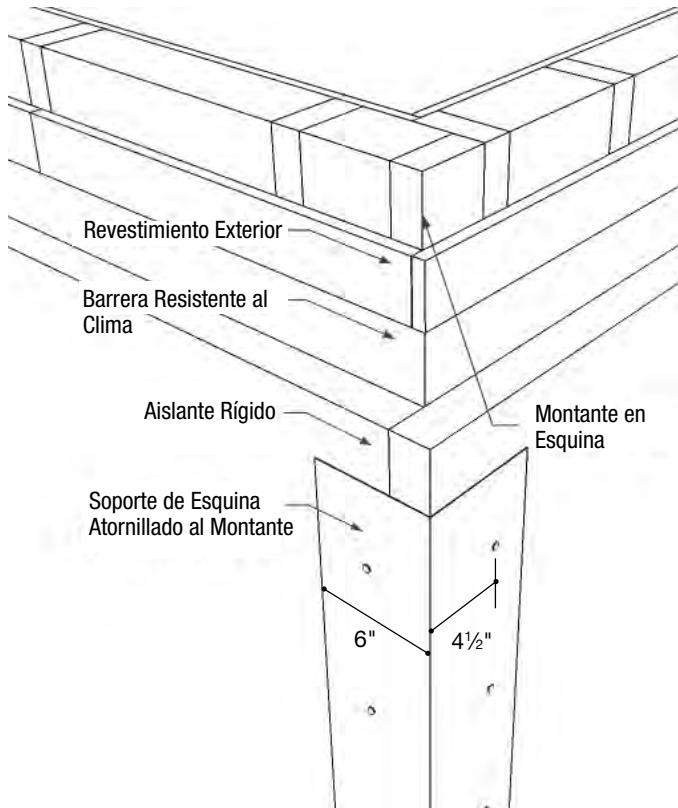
SOPORTE DE ESQUINA ATORNILLADO A TRAVÉS DE AISLANTE
